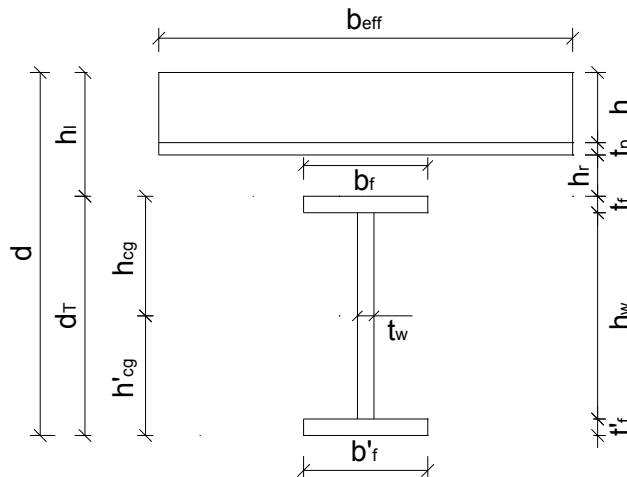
Representación general de la sección transversal compuesta. Viga perpendicular a las nervaduras de la lámina de acero.
